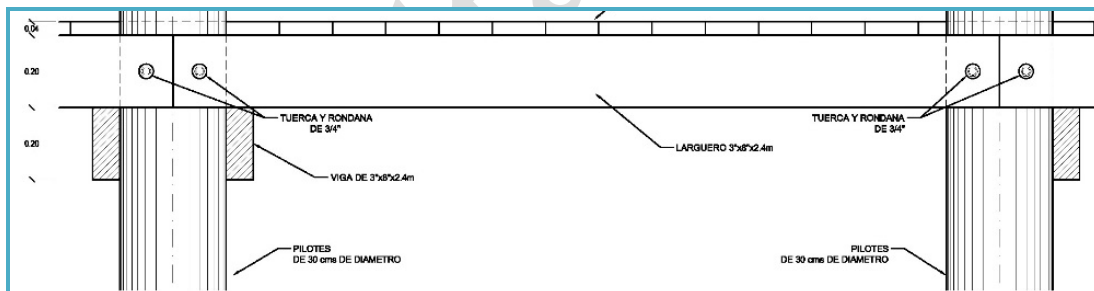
Detalle longitudinal de la sección tipo muelle de los andadores.
